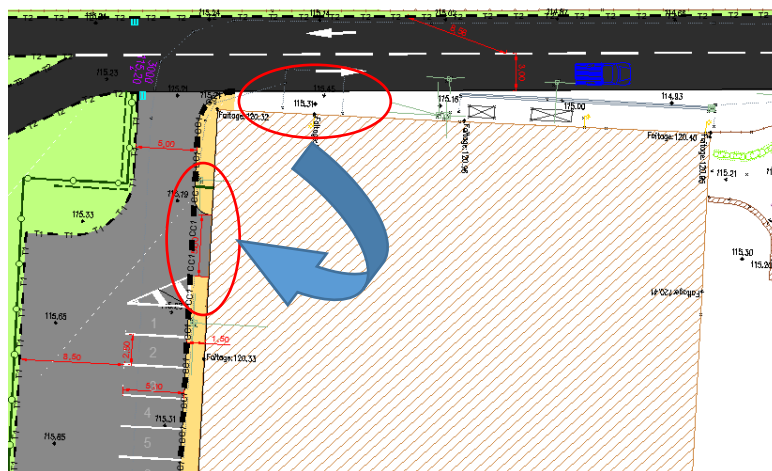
Focus sur le plan d'AVP avec repositionnement de la porte d'accès au local de la CCCA
